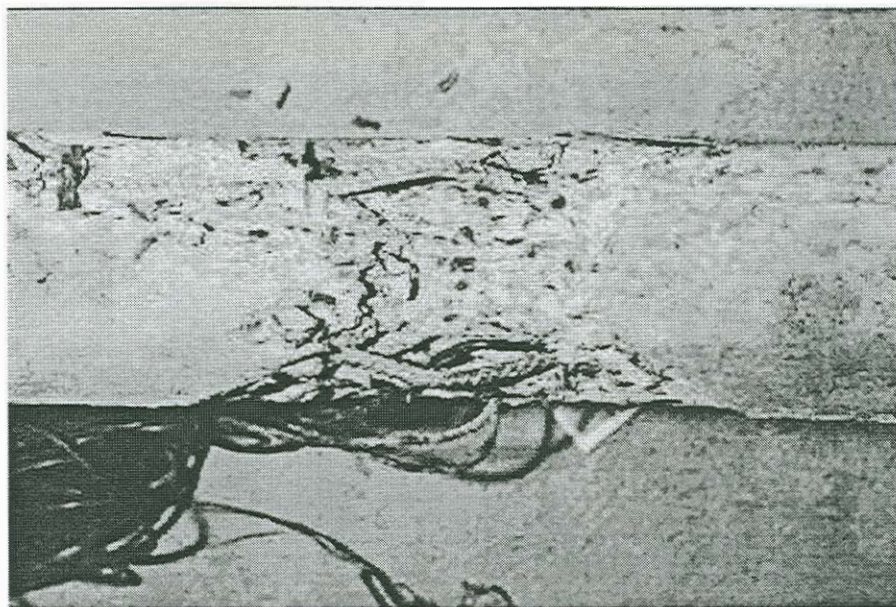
Pilar reforçado com concreto armado em 2 faces opostas.
